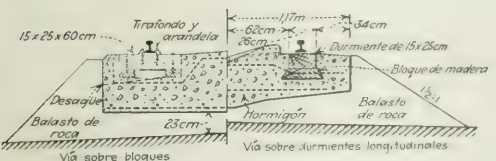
SOPORTES DE HORMIGÓN PARA VÍA DE BALASTO
